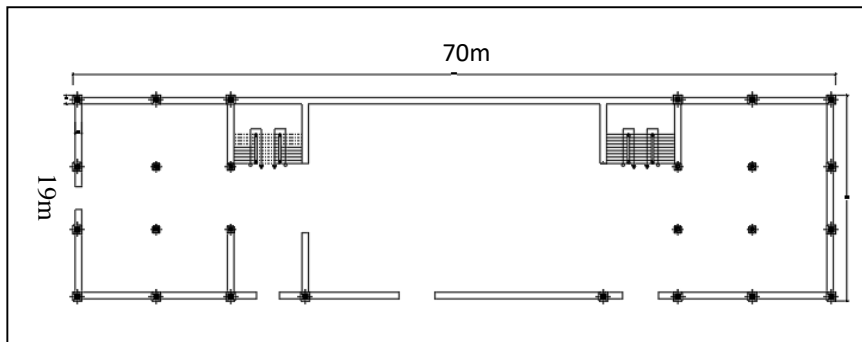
plan explicatif du bâtiment d'ancienne caserne,
